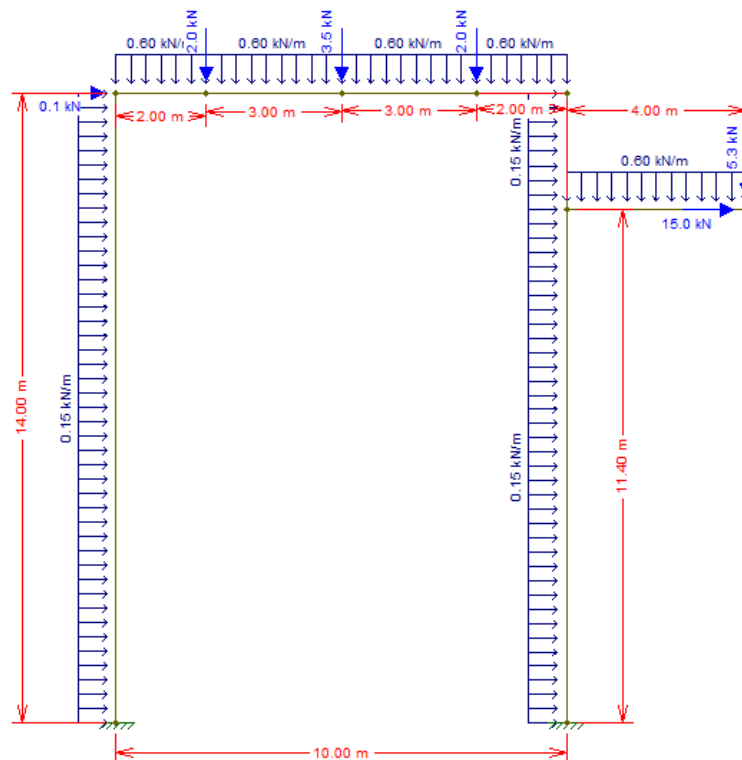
Modelo estrutural do pórtico Leste e Oeste.
